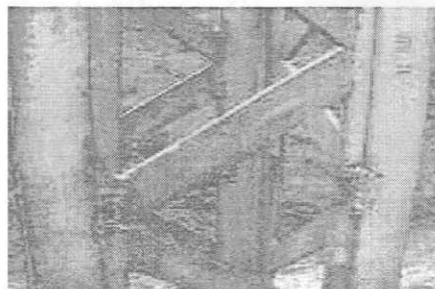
Deficiencias en soldadura. Puente Quebrada Blanca (Meta).
